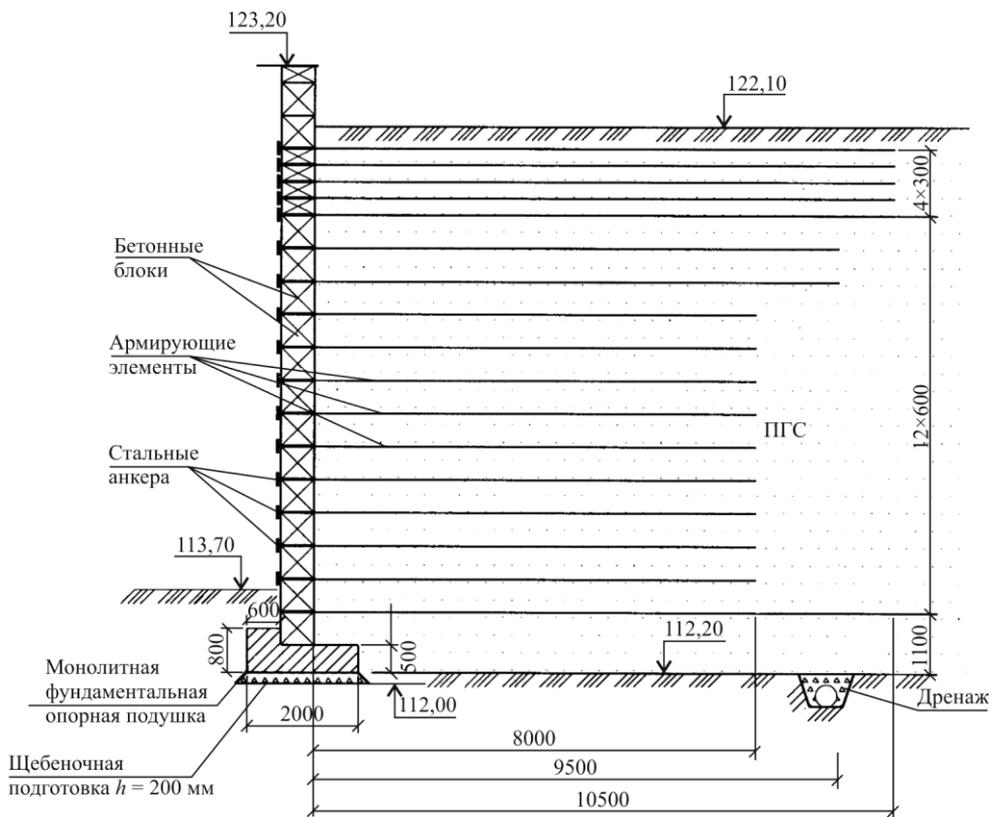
Конструкция подпорной стенки из армированного грунта
